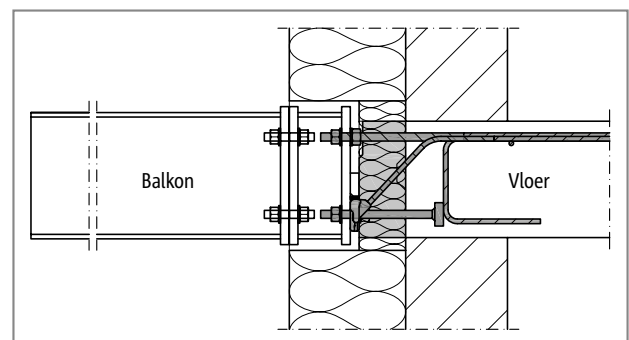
Schöck Isokorf® T type SK: barrièrevrije overgang door hogere positionering
